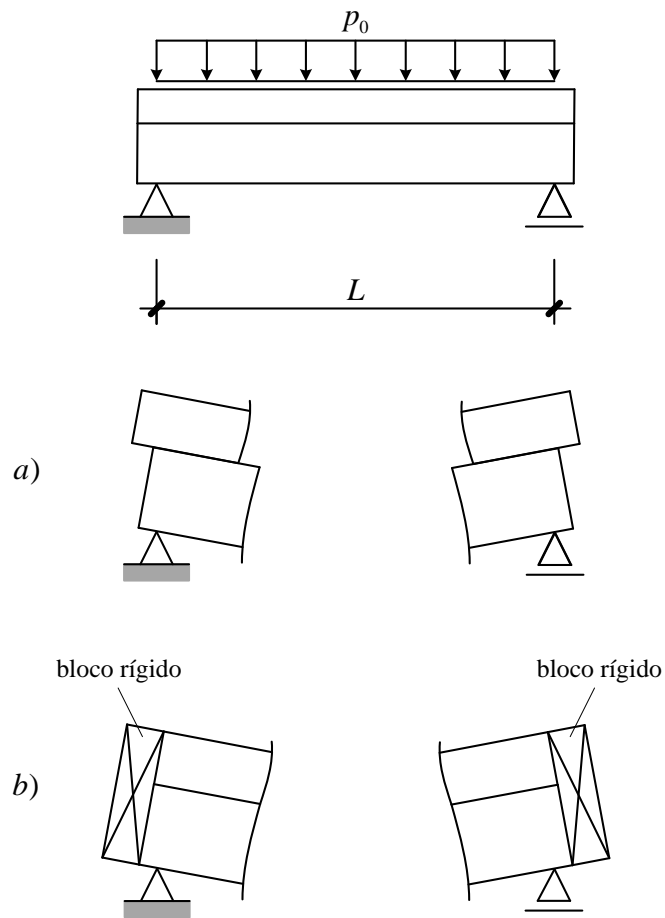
Exemplo ilustrativo – Viga mista simplesmente apoiada com carga transversal uniformemente distribuída
